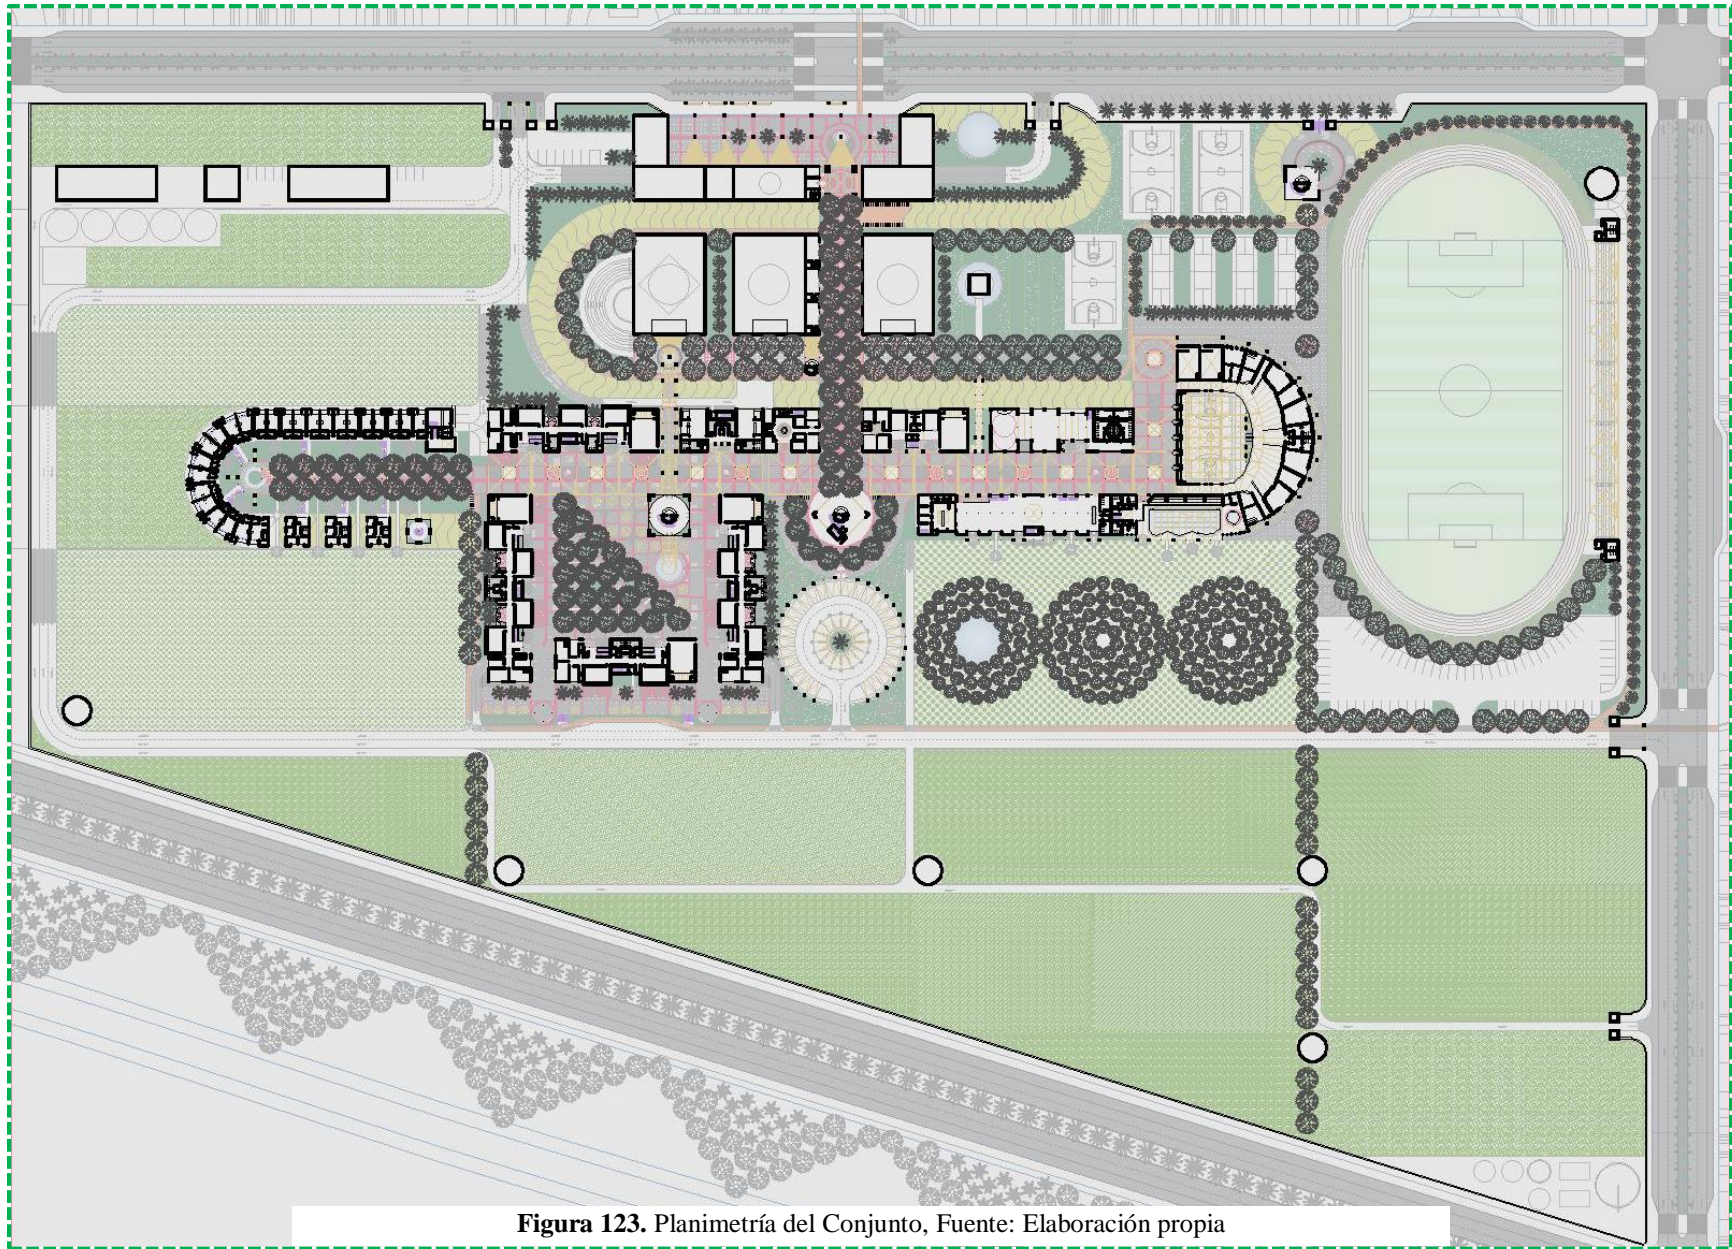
Planimetría del Conjunto, Fuente: Elaboración propia
